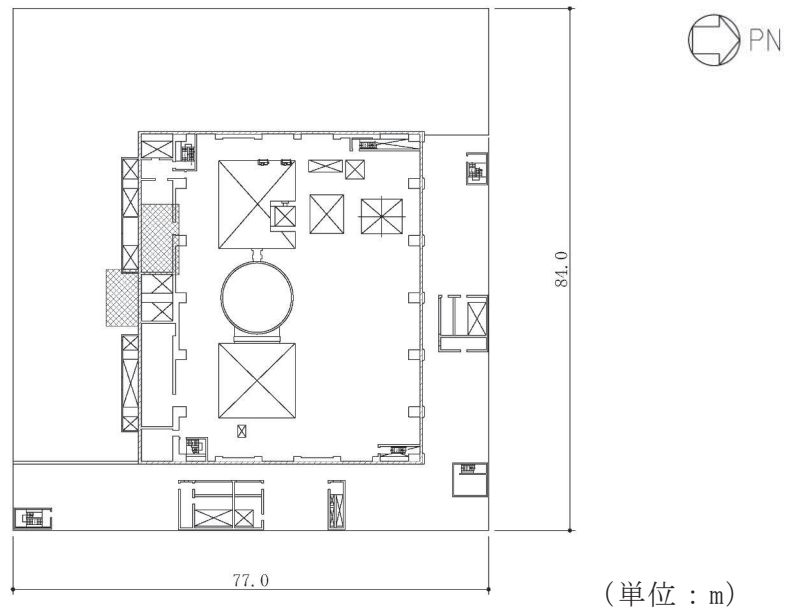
(4) 原子炉建屋原子炉棟（二次格納施設）の範囲の平面図
